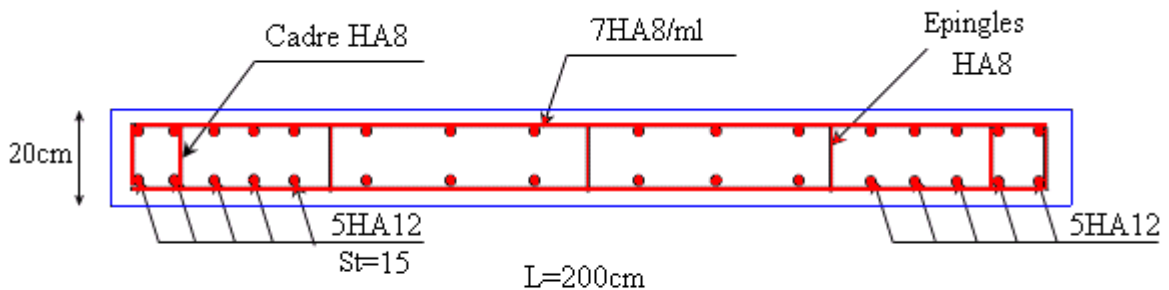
Schéma de ferrailage du voile I au niveau de RDC.
